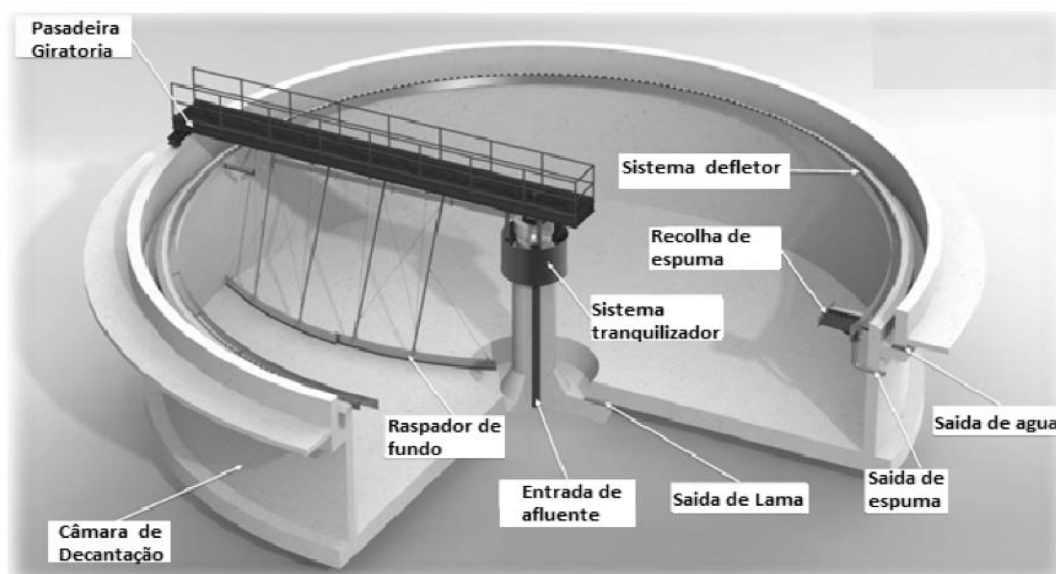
Decantador troncocónico de planta circular (adaptado de <http://omniawater.es>)
